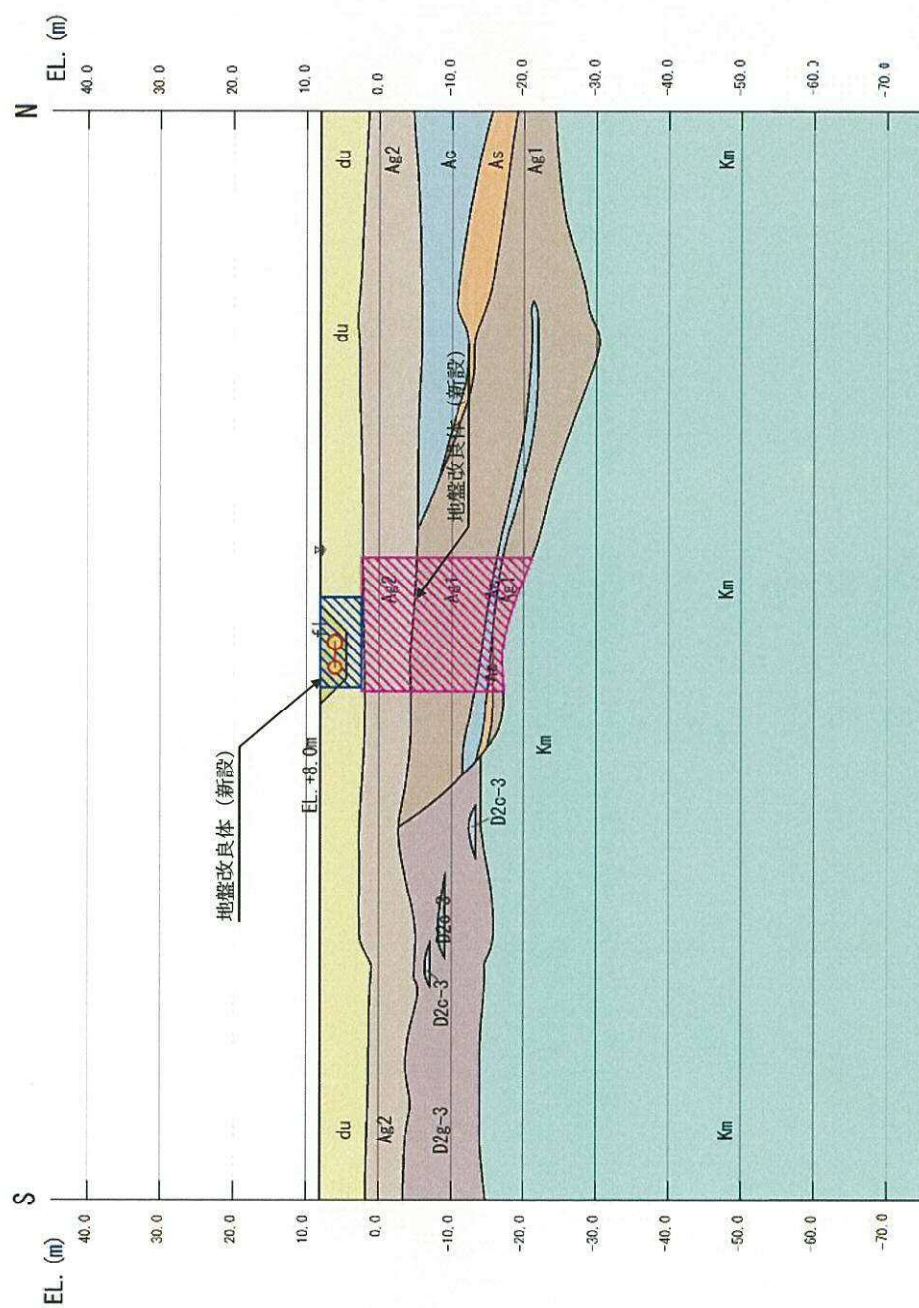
(4) 屋外二重管の横断面図 (C-C断面・地盤改良体基礎構造部) (区間Ⅲ 候補断面⑥-2)
